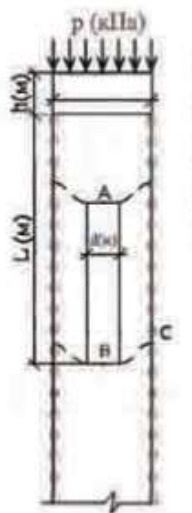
Расчетная схема к определению приведенной жесткости грунто-свайного массива [191]. Анализируемые точки: А – в центре сваи под подошвой ростверка; В – под нижним концом сваи; С – в уровне низа сваи на границе вырезанного фрагмента грунта
